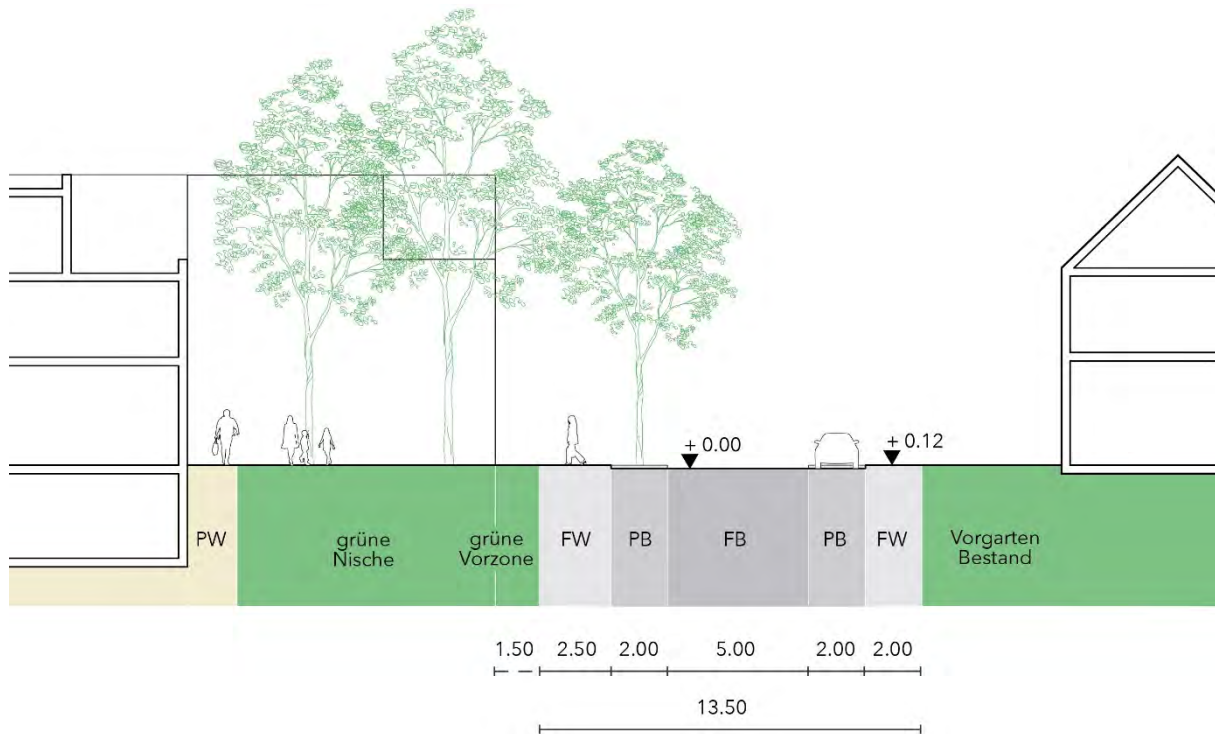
Straßenquerschnitt Kirschgartenstraße, Quelle: Teleinternetcafé GbR / TH Treibhaus
